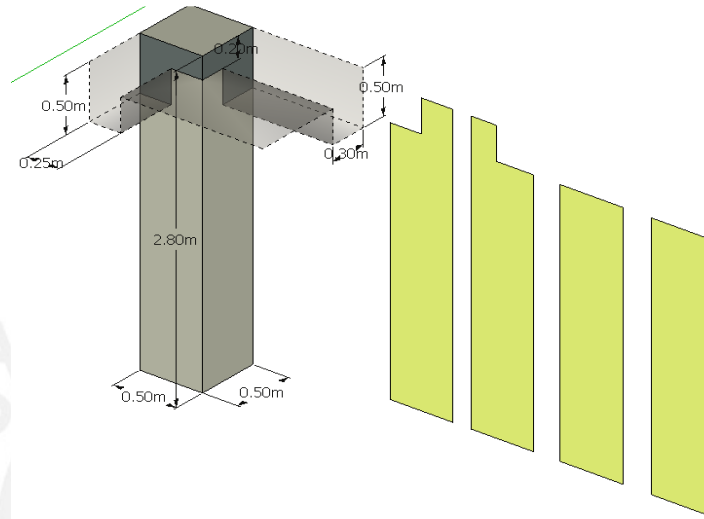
Encofrado de columna (Adaptado de SOUZA 2000)
